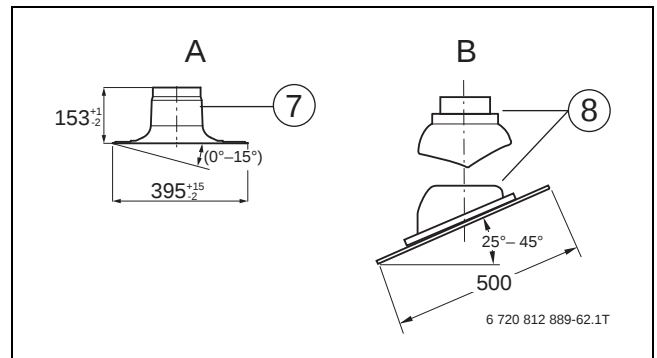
Universaldachpfannen und Flachdach-Klebeflansch als Zusatzausstattung für den Grundbausatz DO (unbedingt mitbestellen), (Maße in mm)
